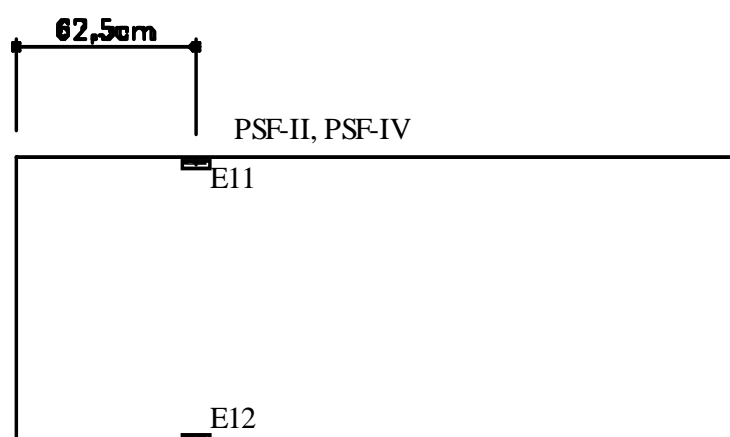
(a) – Disposição dos extensômetros colados na armadura das nervuras
